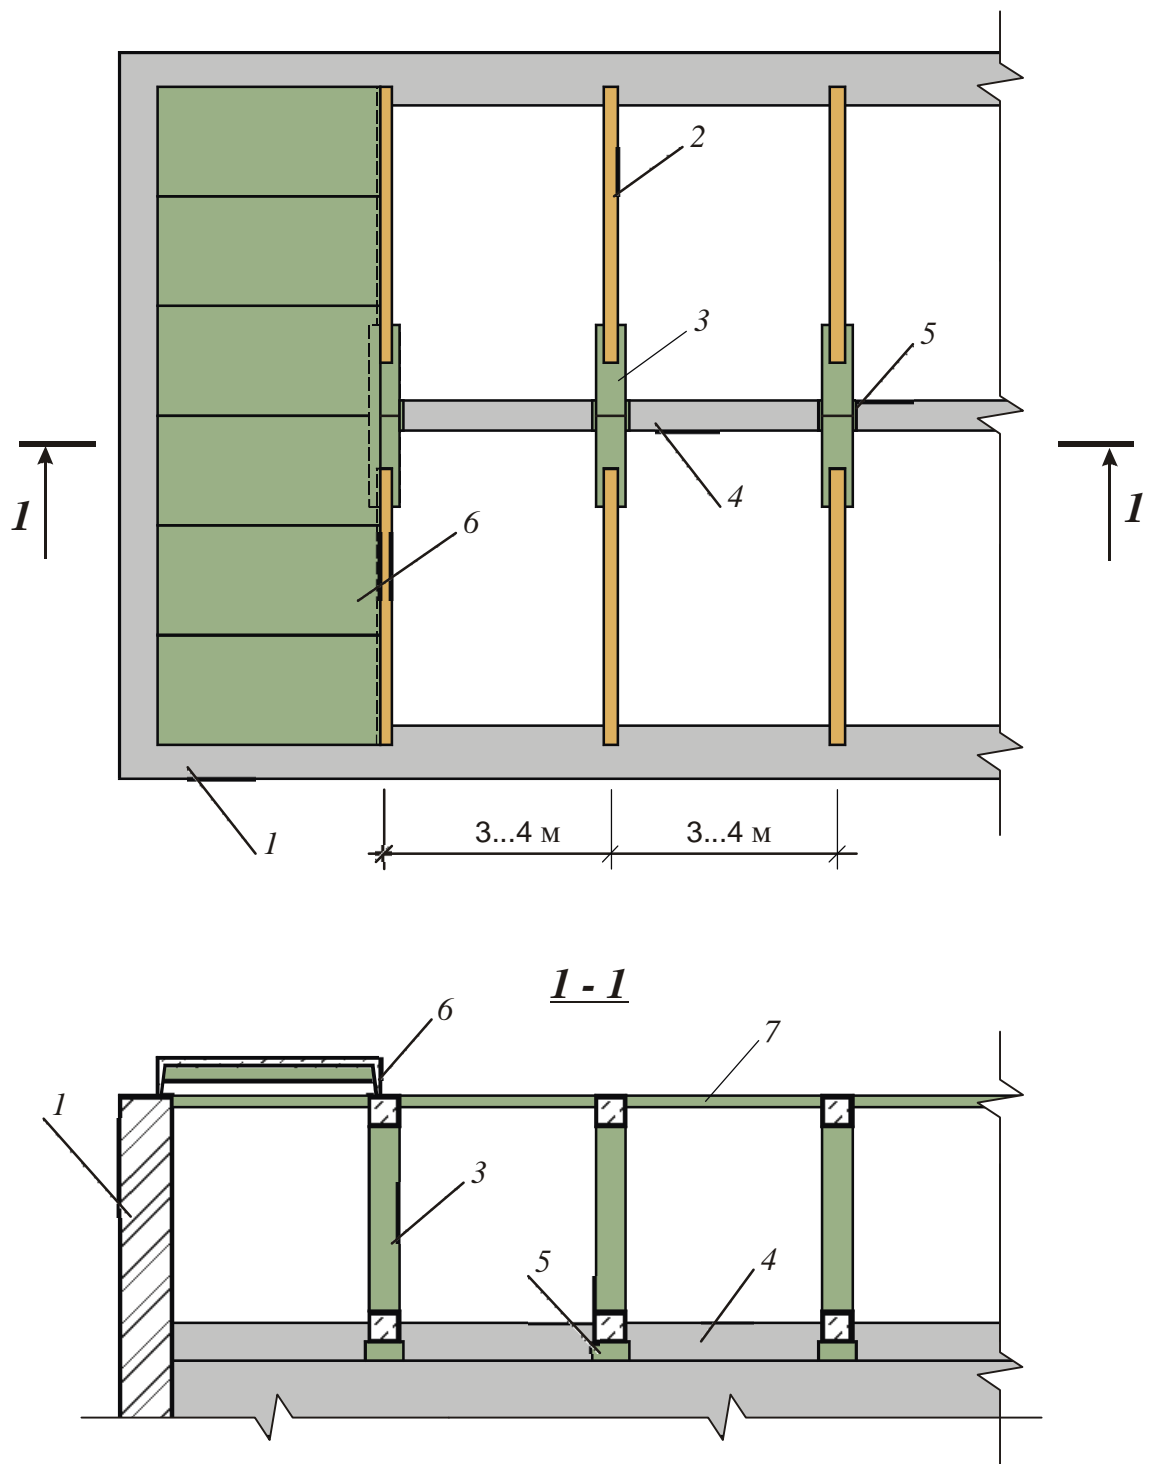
Крыша из ребристых железобетонных панелей, стропильных ферм и ног:
